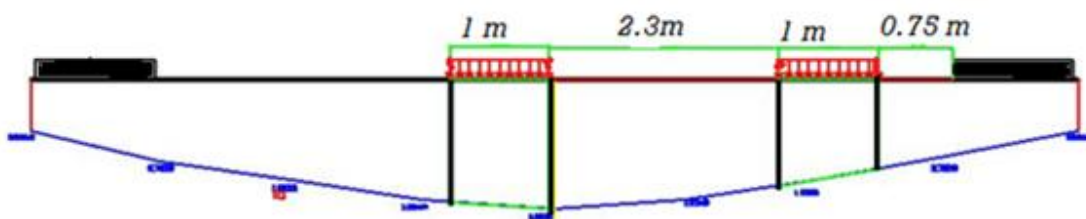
disposition du convoie Mc120 poutre centrale
